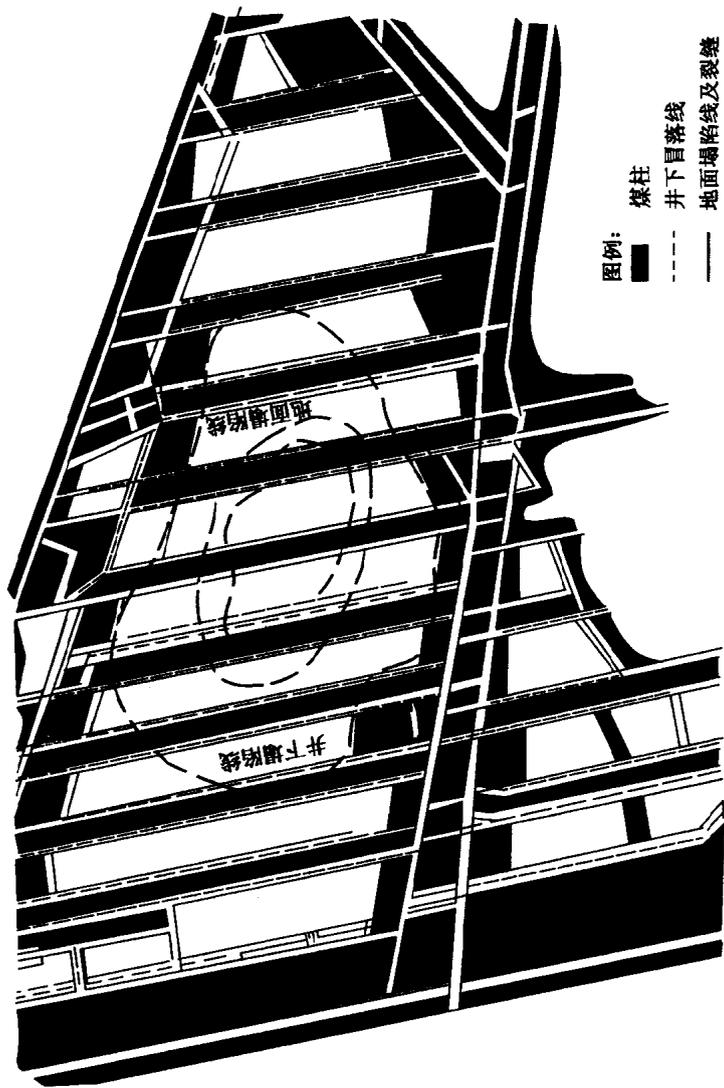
雁崖矿 11# 层 301 盘区短壁工作面井下与地面塌陷平面图
